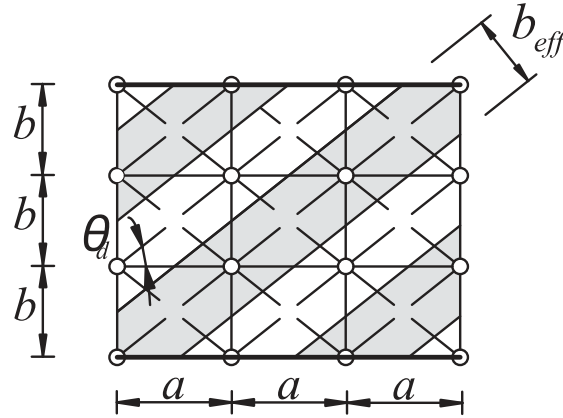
Modelo de puntales para muro de concreto reforzado.
